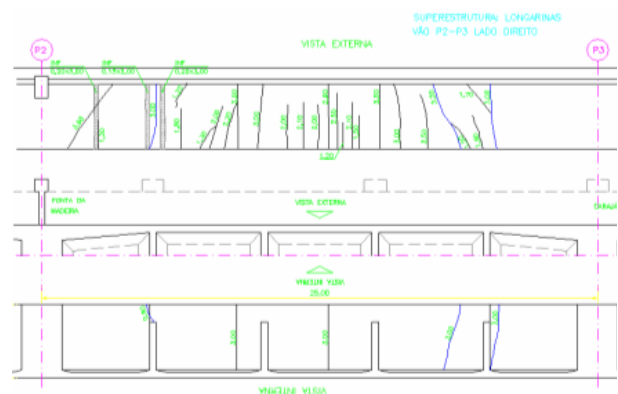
Mapa de fissuração de uma ponte [1]
